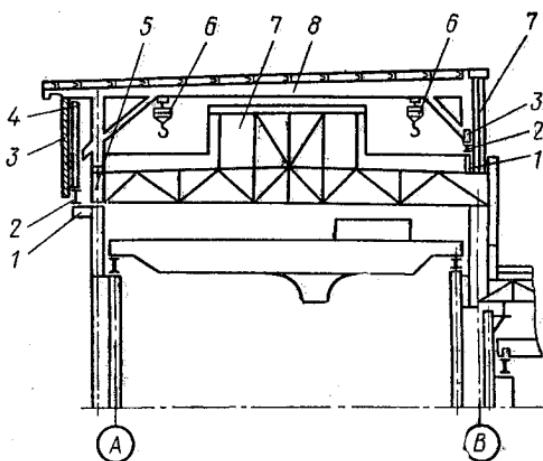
Поперечный разрез пролета производственного здания медеплавильного завода в процессе замены конструкции покрытия:
